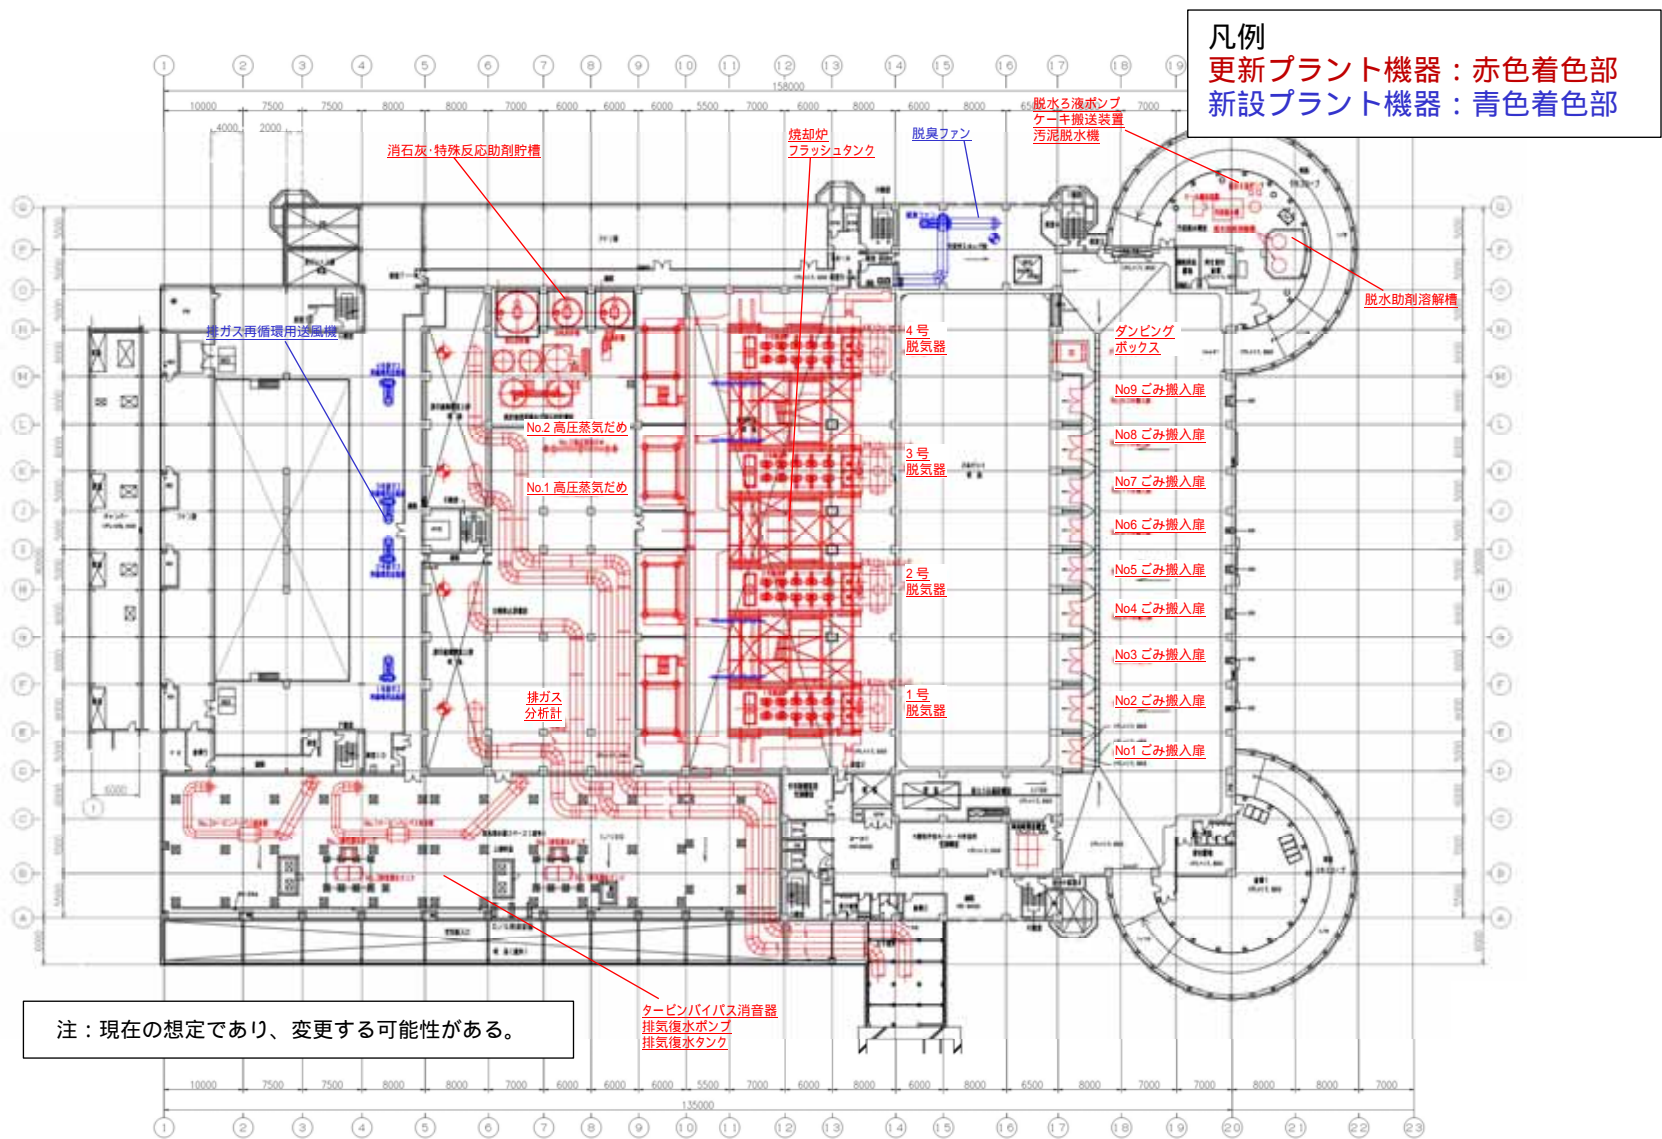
(5) 設備機器の更新箇所 (5階平面図)
